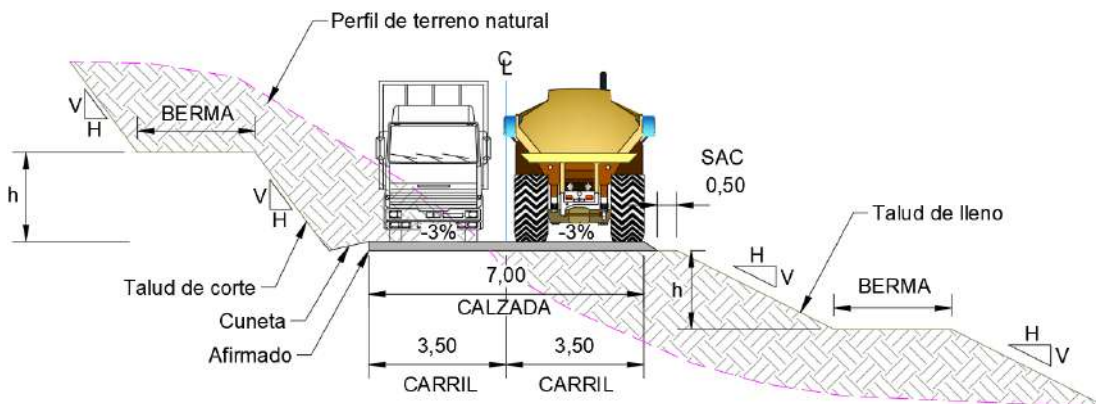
Sección típica vía para construcción – Vías con ancho de 7 metros
